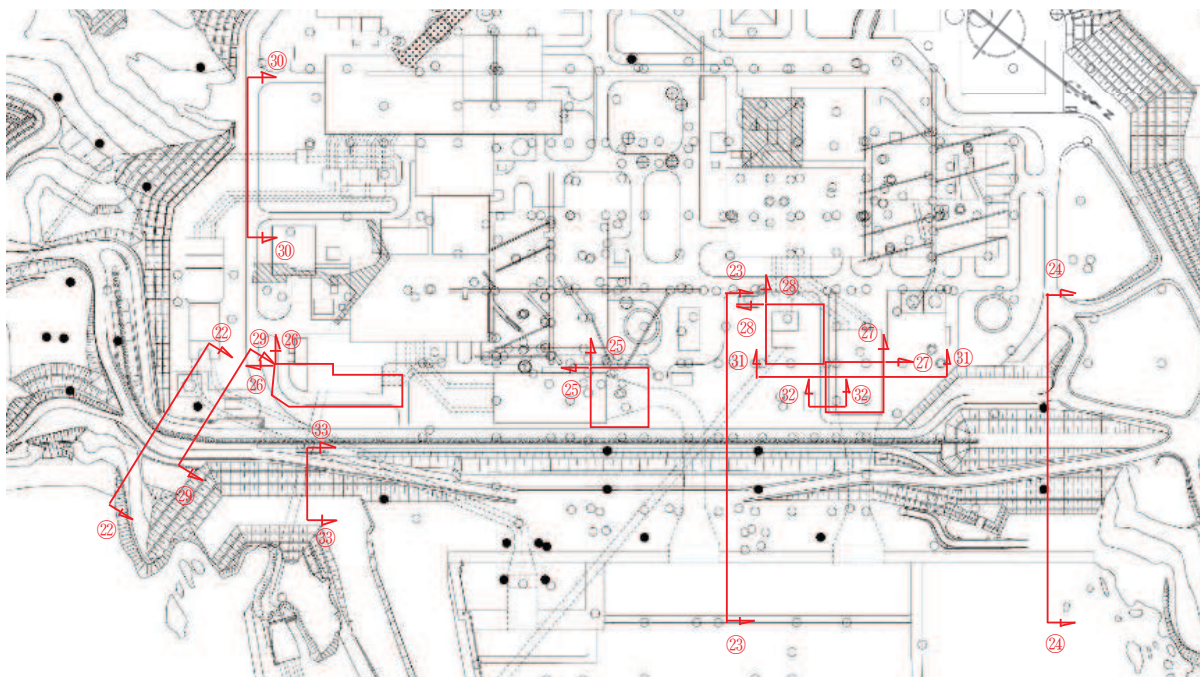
(3) 地質断面図位置 (22-22断面～33-33断面)
